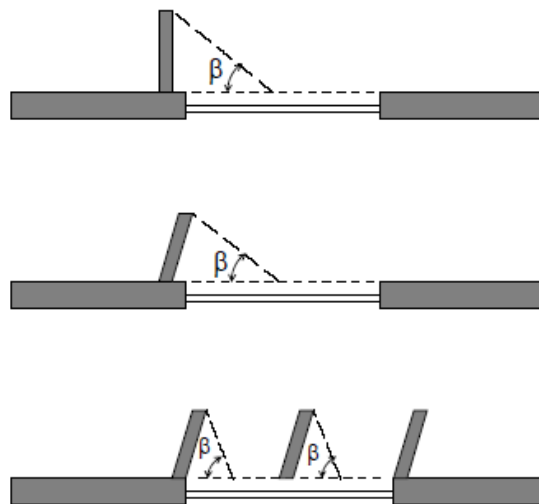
Exemplos de medição do ângulo β de palas verticais (secção horizontal) [7]
